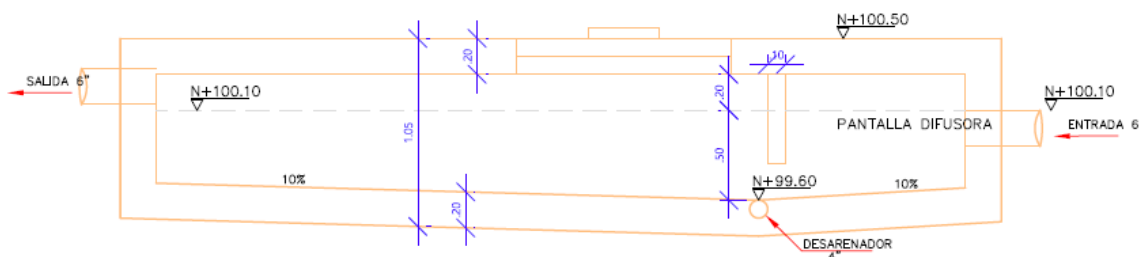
Detalle tanque desarenador, sección corte longitudinal
